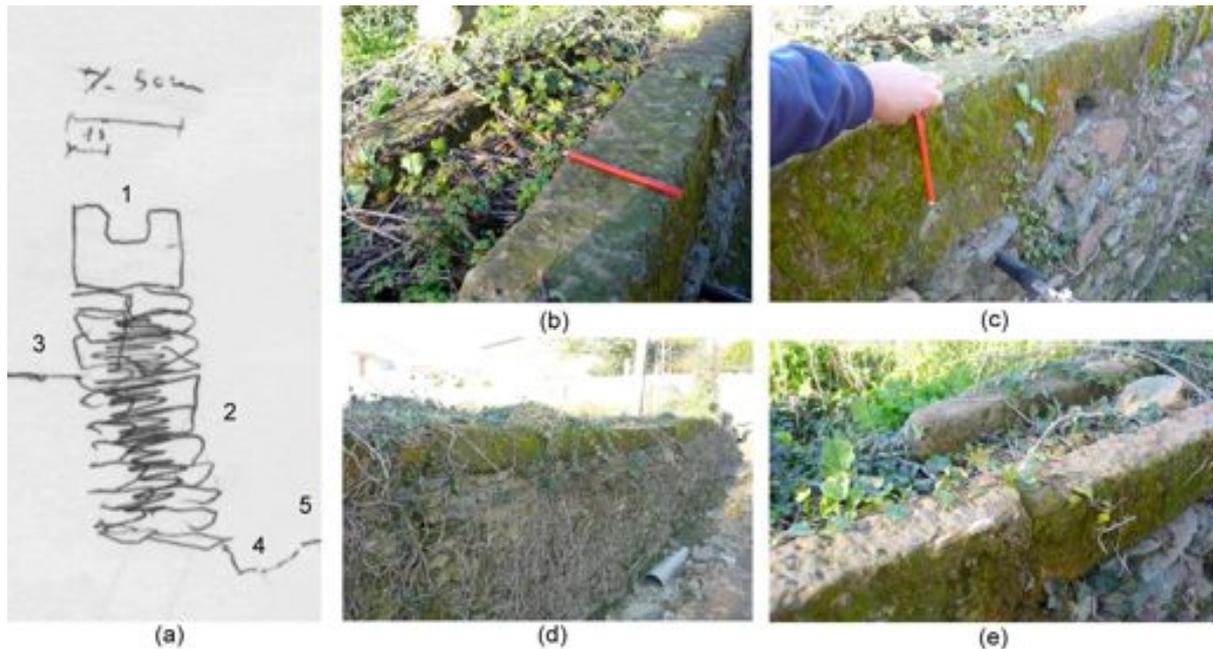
Muro caleira LN14 (a) Secção esquçada de muro caleira observado em Lagoa Negra; (b); (c); (d); (e) Imagens do muro caleira
